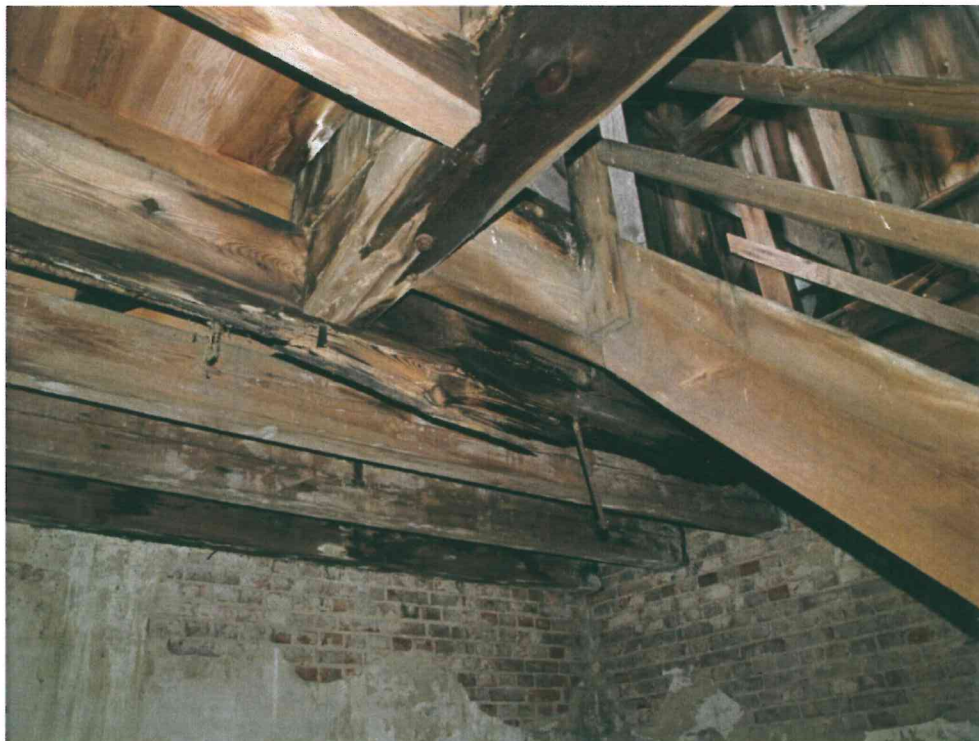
Zawilgocenie deskowania oraz belek konstrukcyjnych dachu
